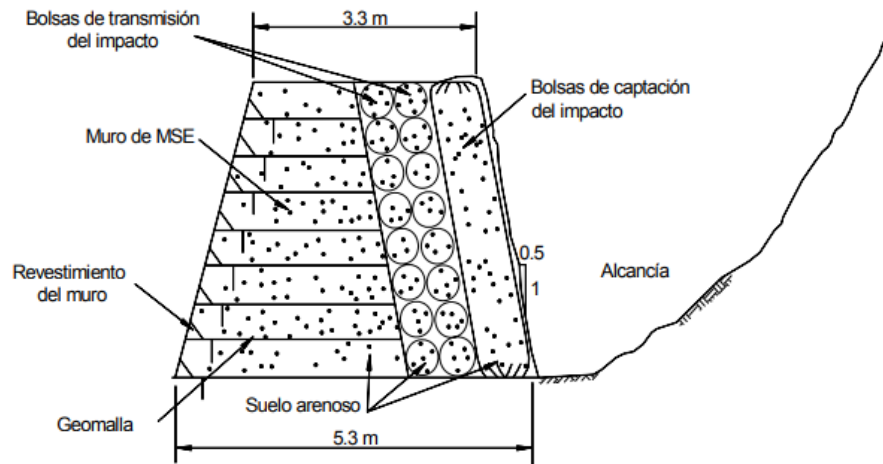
Muro alcancía de tierra armada con geotextiles.
